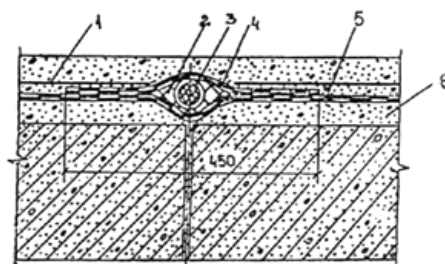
Конструкция гидроизоляции деформационного шва между прогонами:
